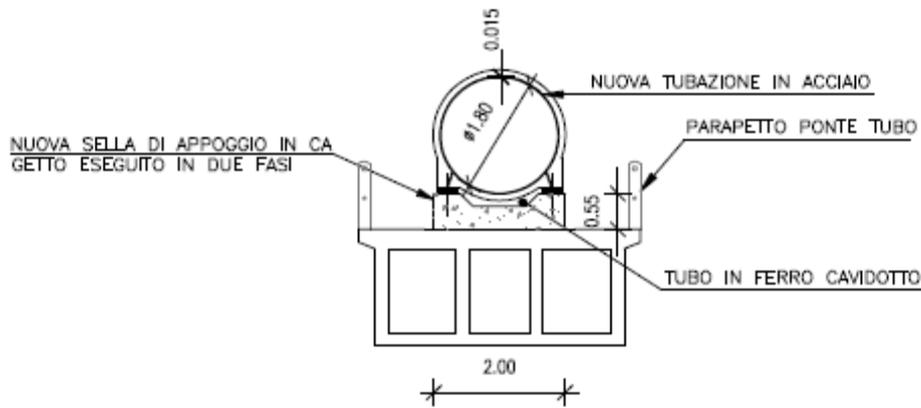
sezione in corrispondenza al ponte tubo della nuova condotta forzata in acciaio.
